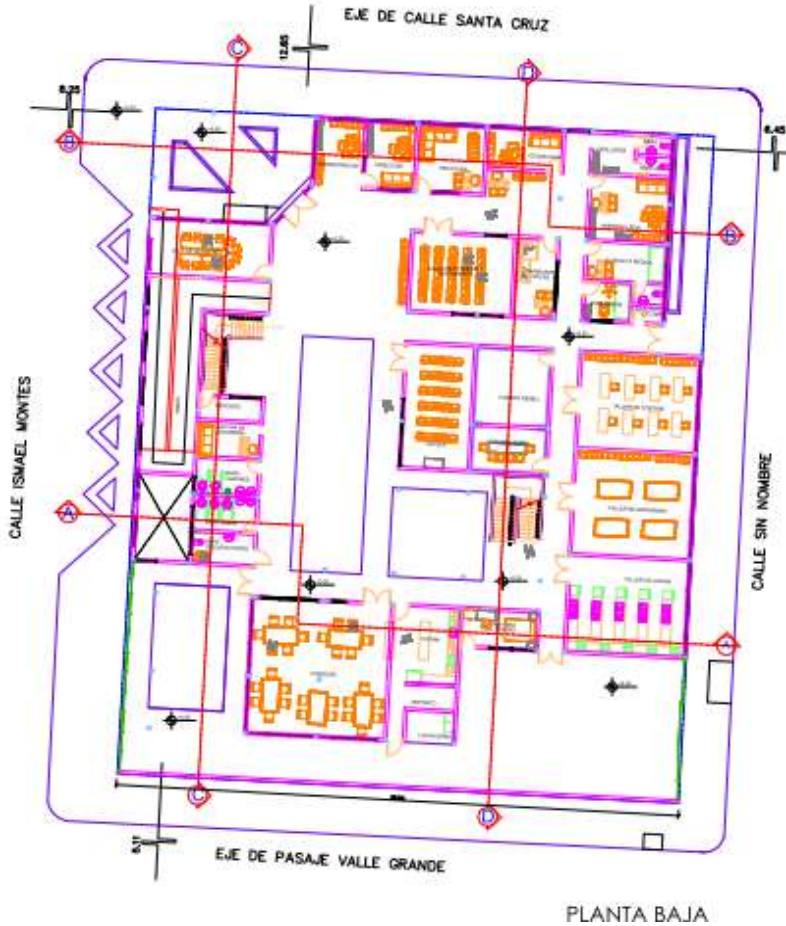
Vista en Planta y Fachada del Proyecto, Fuente: Alcaldía Municipal
